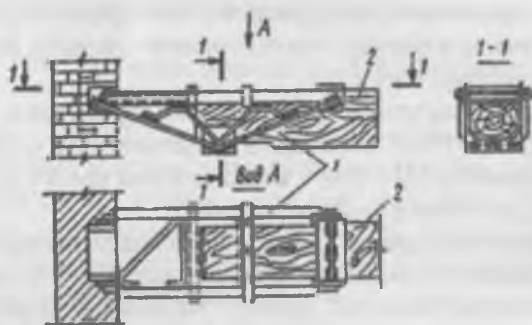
Усиление балок перекрытия прутковыми протезами:
